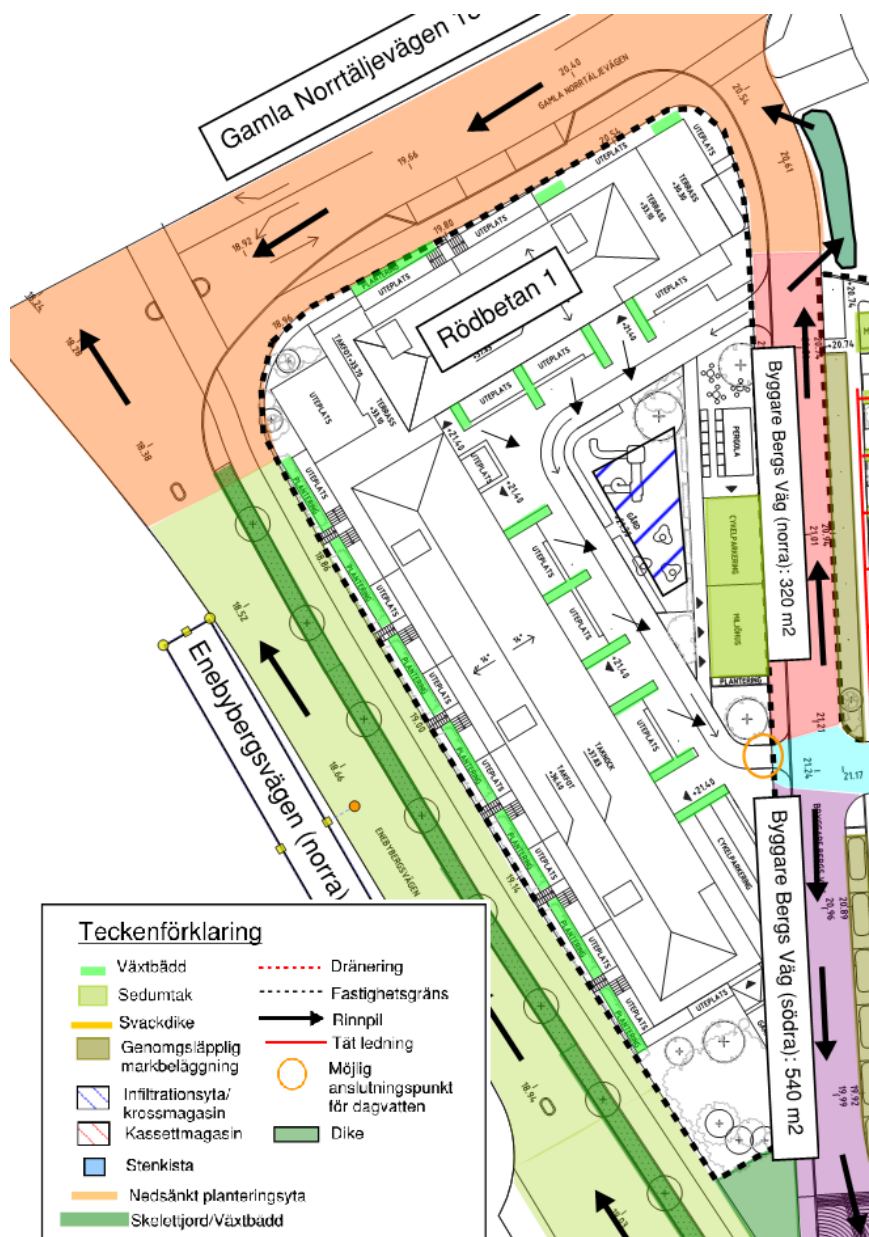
Avvattningsplan över planområdet, se bilaga 1 – avvattningsplan 2025-09-03 för större bild.
